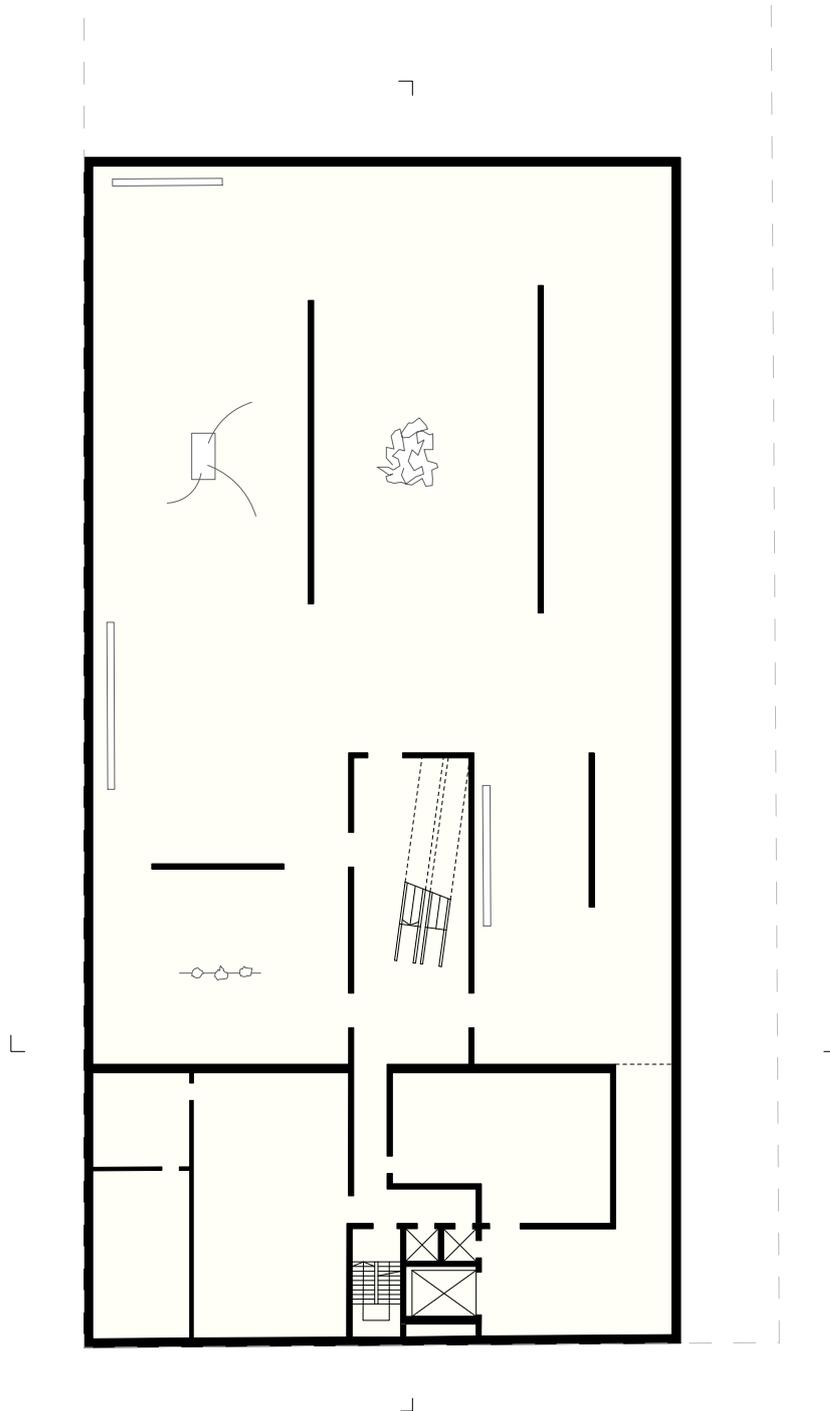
Wettbewerbsbeitrag Grundriss Untergeschoß 3
